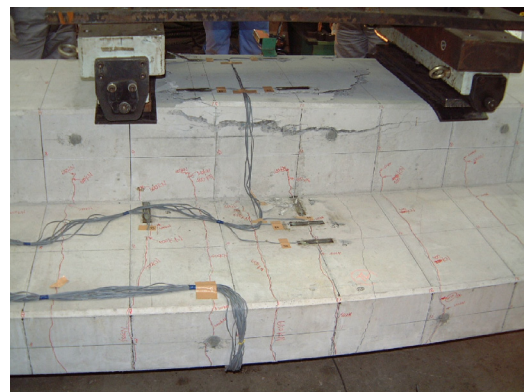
SRC 梁上面コンクリート圧壊状況 (SRCNo.2)
